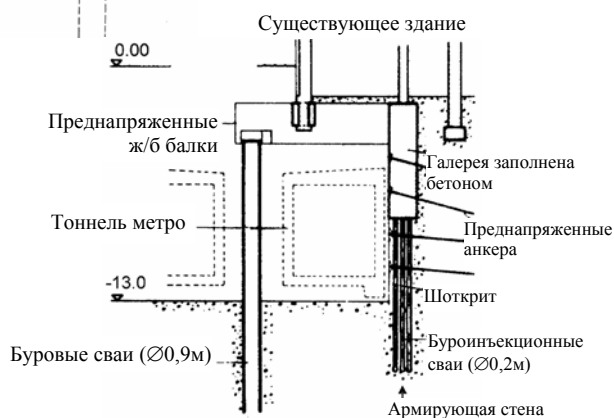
Укрепление фундамента здания с помощью устройства армирующей стены из корневидных свай и буронабивных свай большого диаметра
